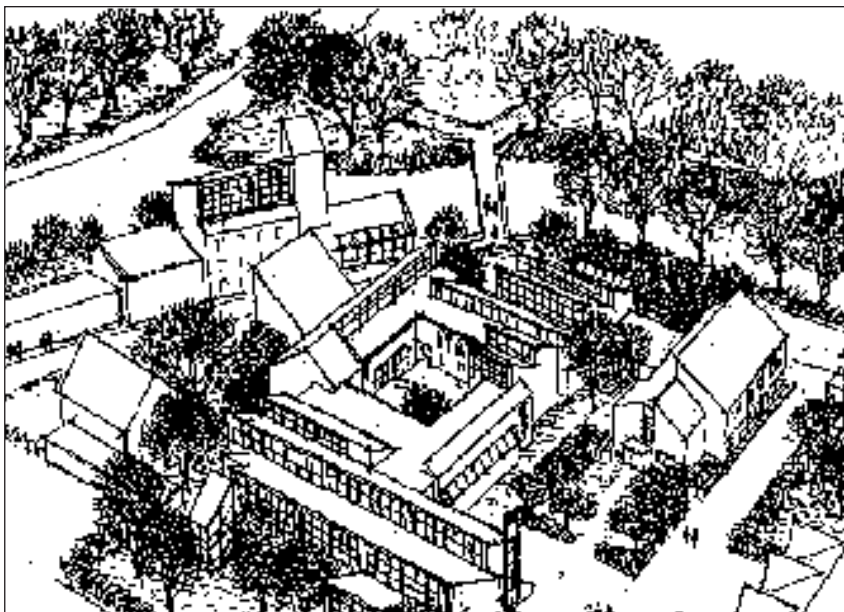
Gesamtansicht der Kunsthalle in Emden mit dem Erweiterungsbau im unteren Teil, nach Norden orientierte Shedstruktur, Zeichnung des Architekten Prof. Friedrich Spengelin
